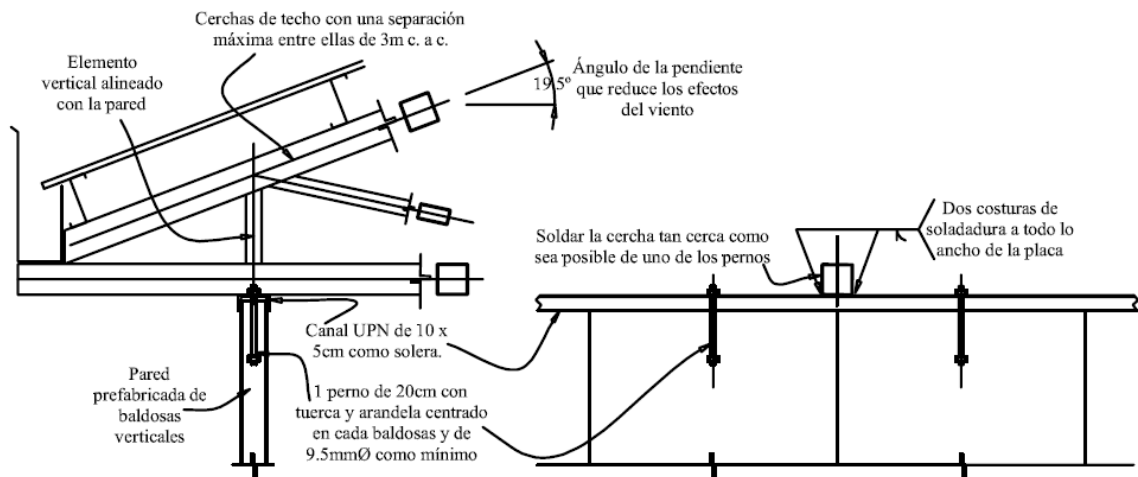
Detalle de apoyo de viga de techo en pared de mampostería
